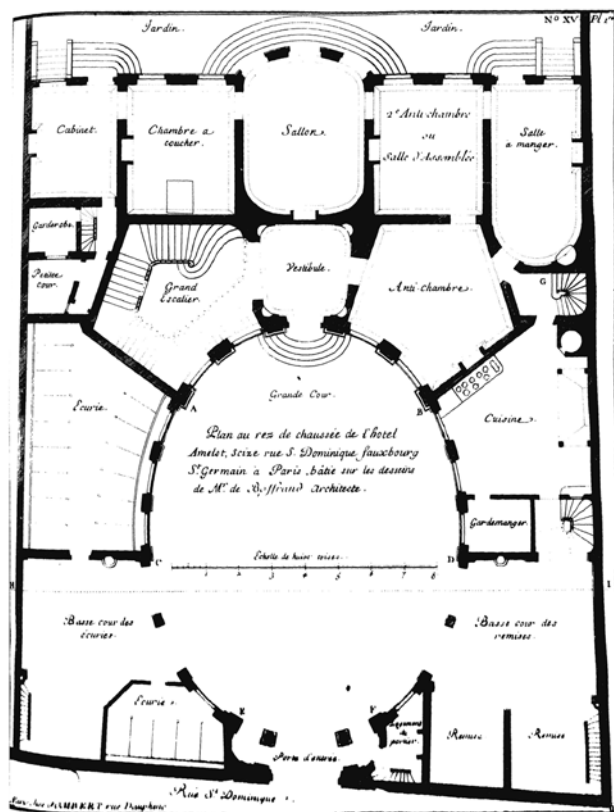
Planta del Hôtel Amelot. Fuente: Blondel (1752a).
